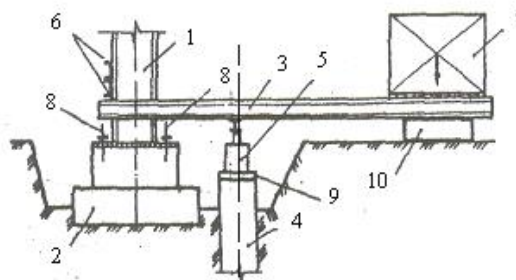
Вывешивание металлической колонны здания с помощью рычажной установки для замены столбчатого фундамента:
